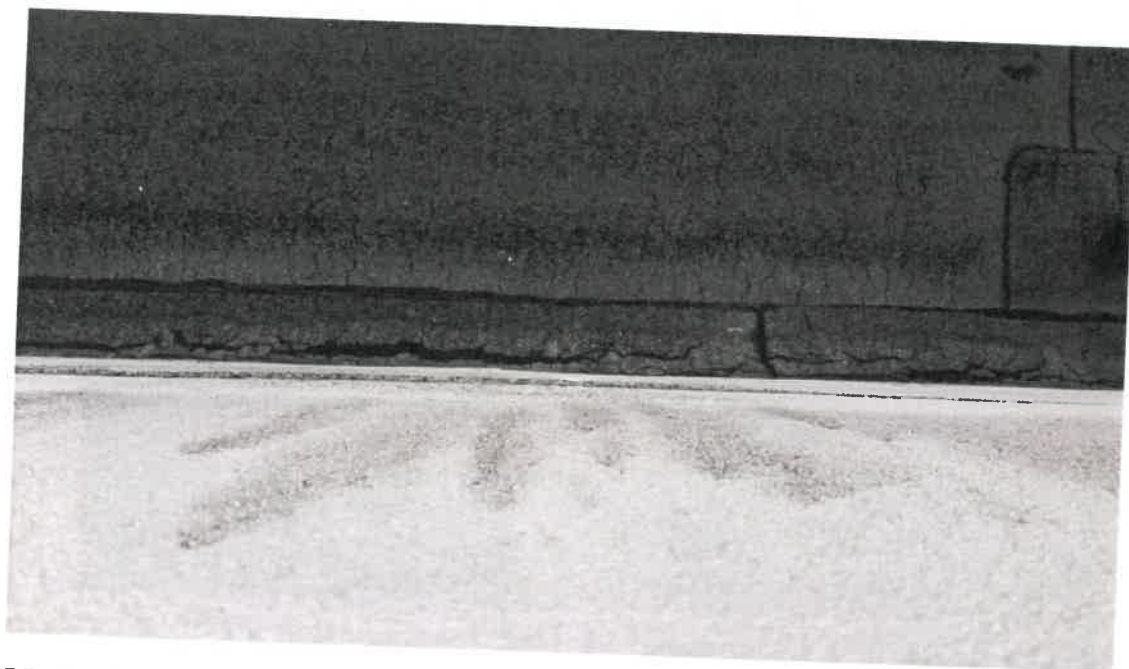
Risse in der Bitumenbahn Bereich Wandanschluss Dachabdichtung des Anbaus
